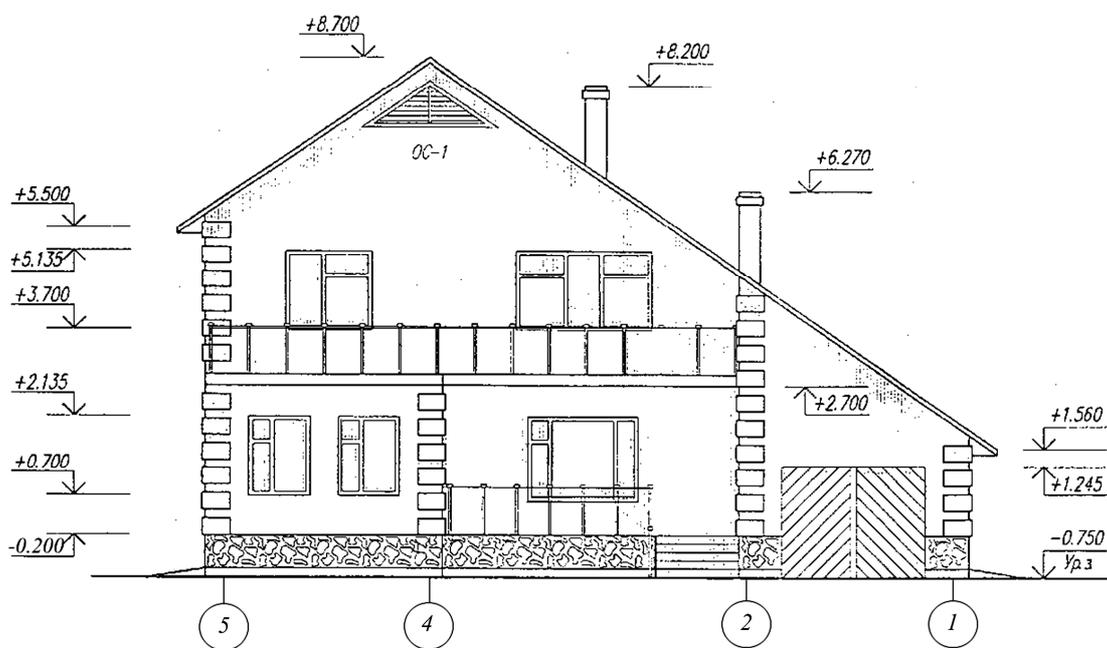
Пример выполнения фасада малоэтажного жилого здания
